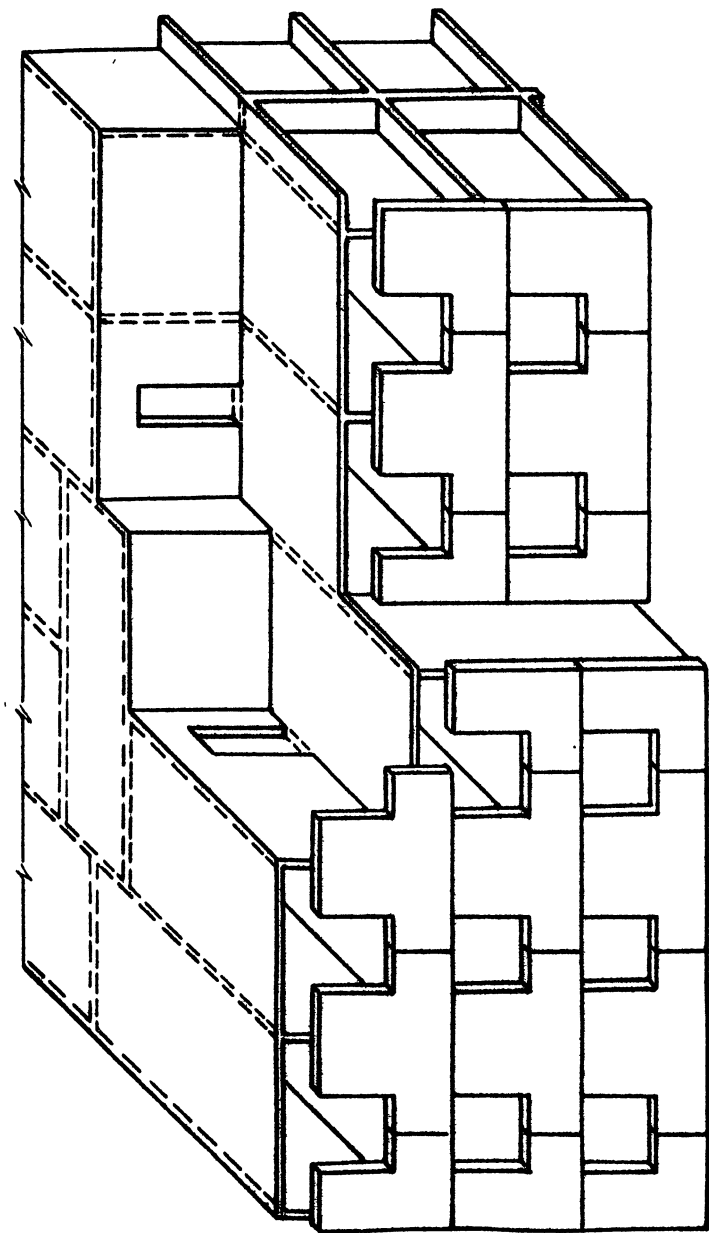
Здание перекрестно-стенной конструктивной системы с несущими наружными стенами из сборных панелей
